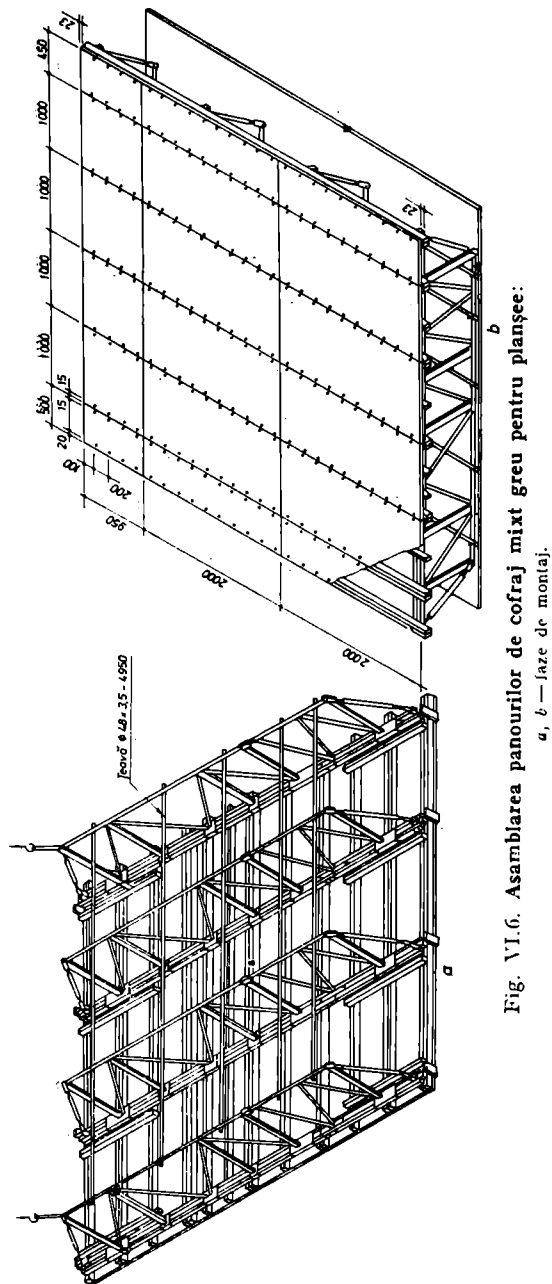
Asamblarea panourilor de cofraj mixt greu pentru planșee:
